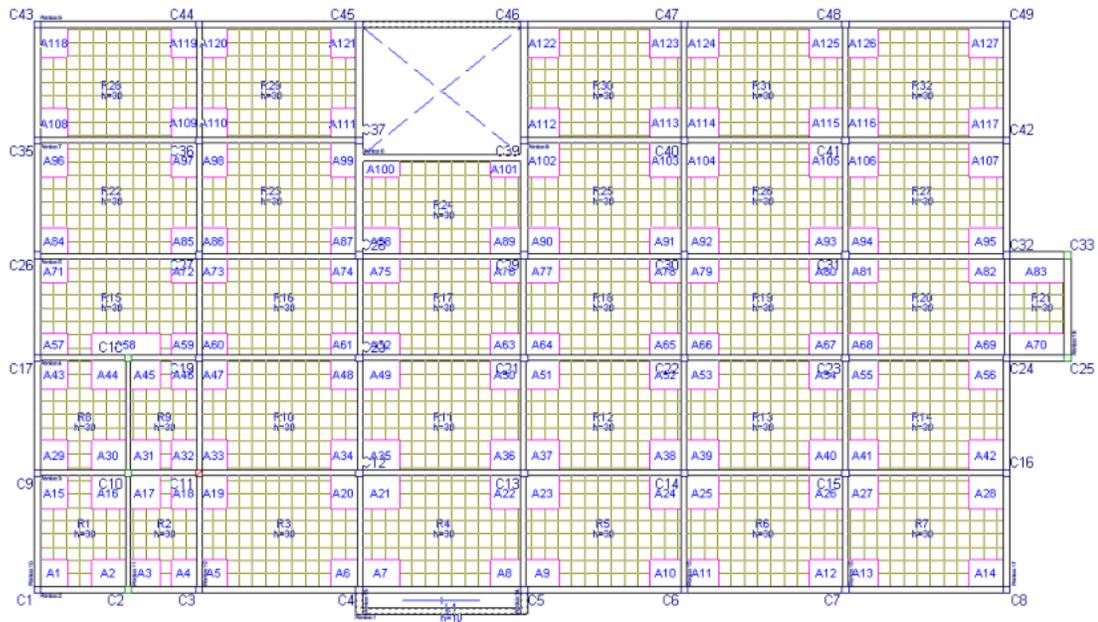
Vista en planta losa $h=30\text{cm}$ con vigas de arriostre.⁹
